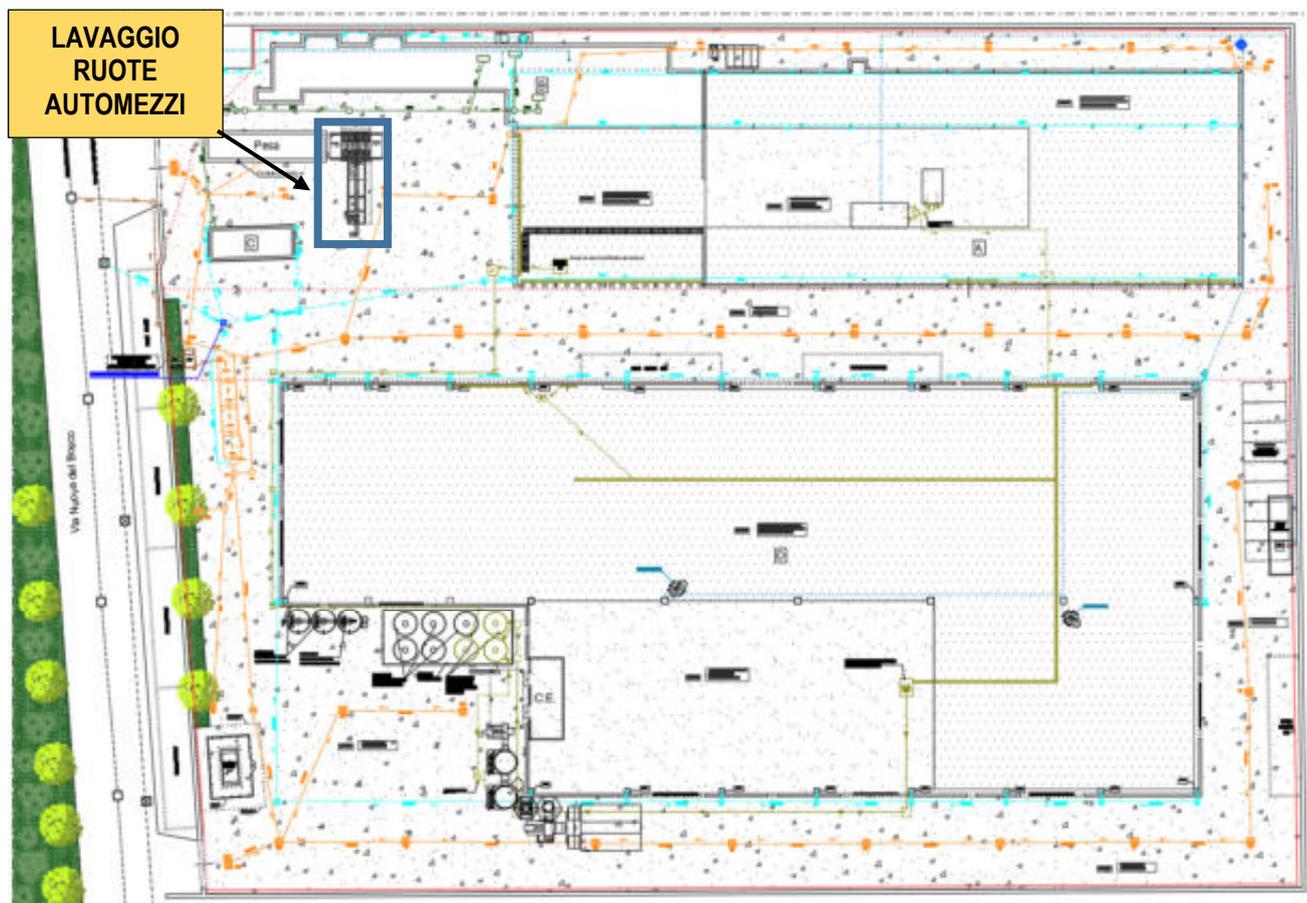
Stralcio planimetrico con individuazione del sistema di lavaggio ruote automezzi
